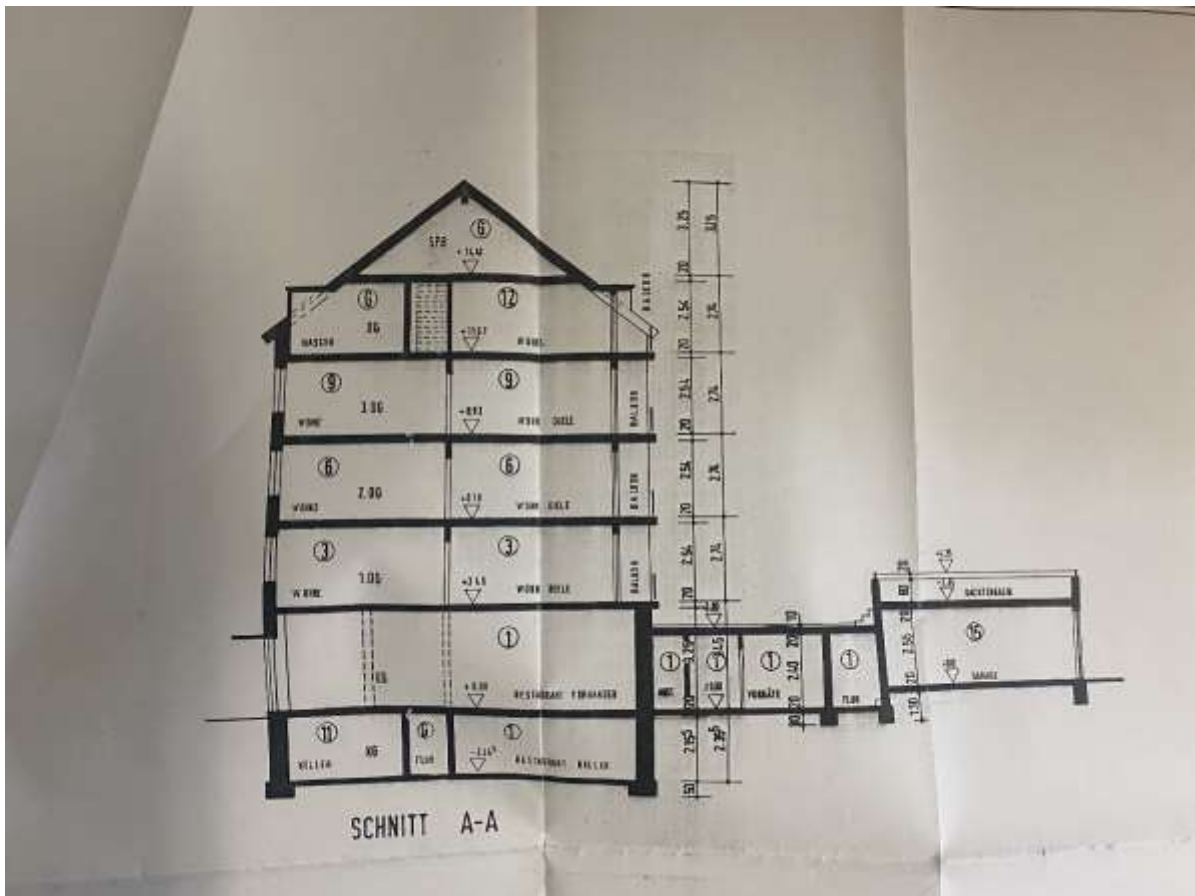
Schnitt / Quelle: Aufteilungsplan Grundakte
